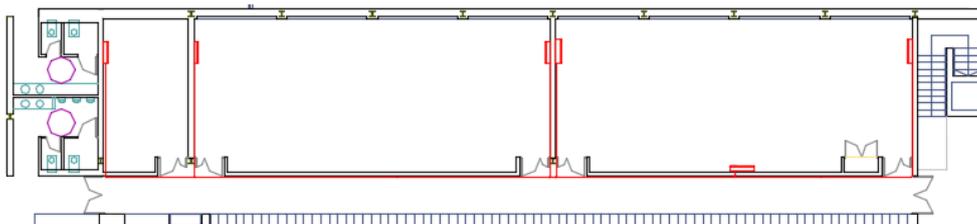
Croquis de la instalación de climatización, Edificio 5 Planta Baja
